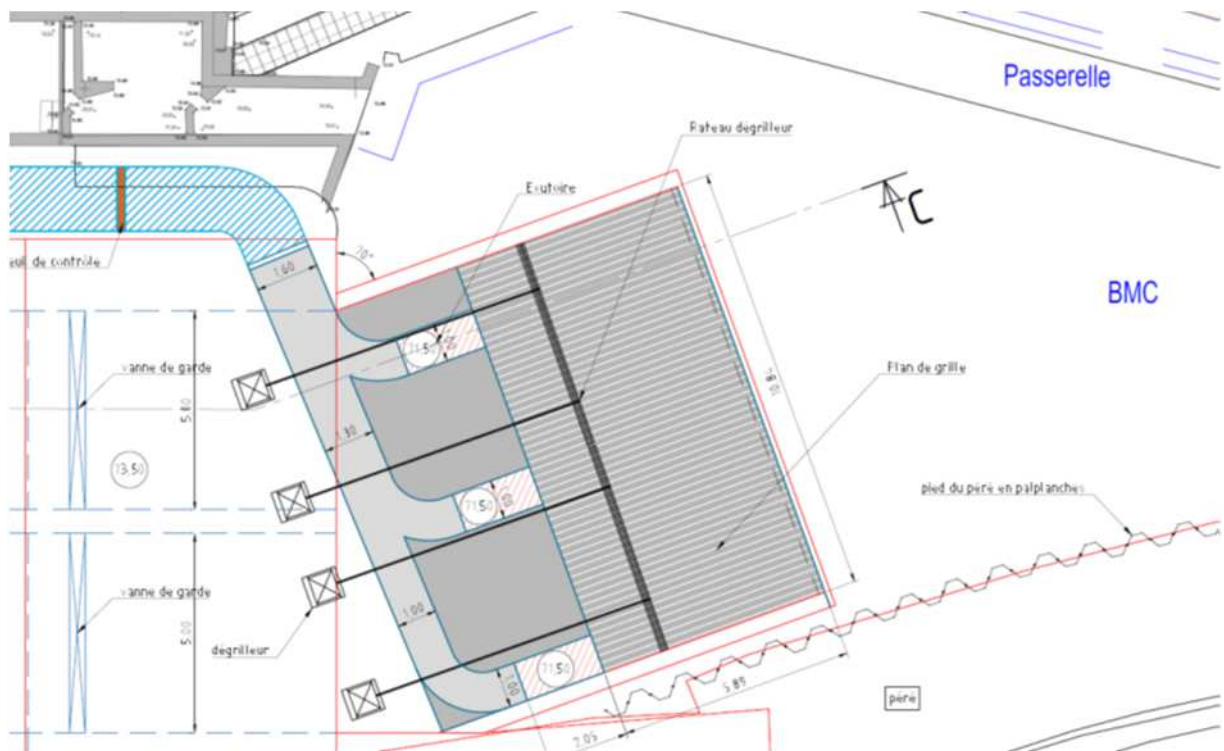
Vue en plan du système de plan de grilles / dévalaison
